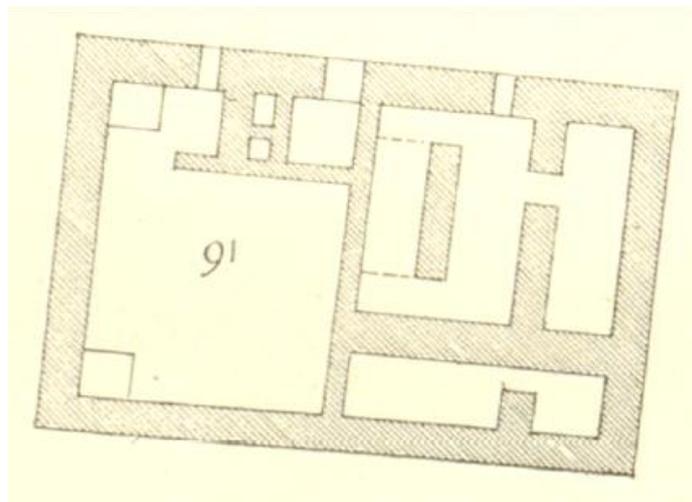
Planta de M91 (GARSTANG 1916: pl.II).
